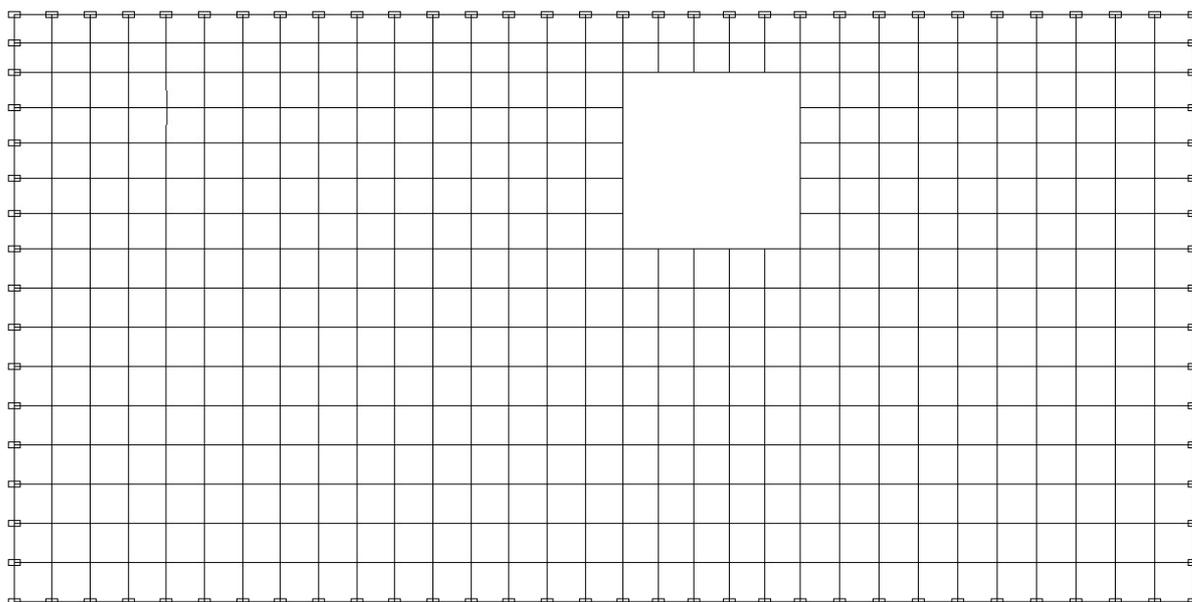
Расчетная схема плит перекрытия и покрытия
